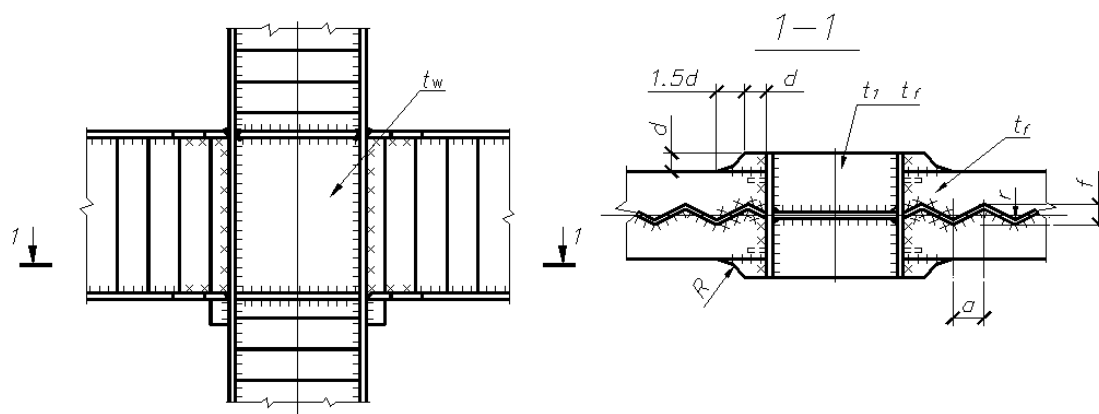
Сварной рамный узел каркаса
